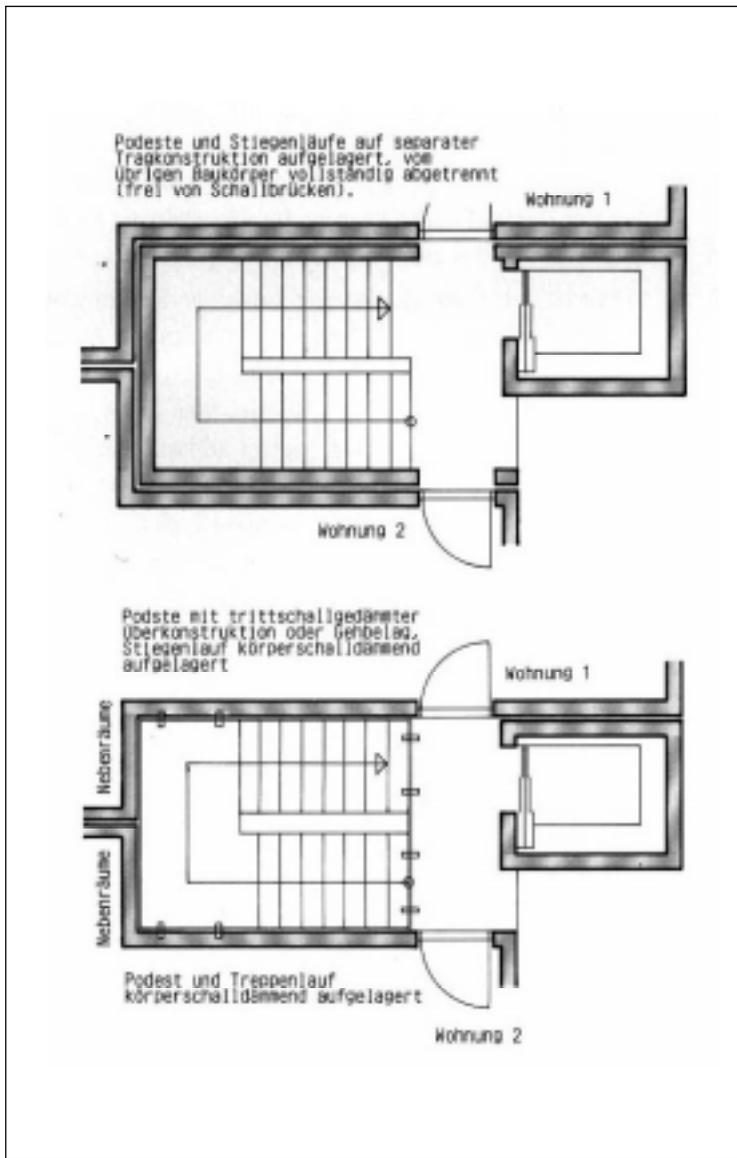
Typische Grundrißlösung zur schalltechnischen Trennung des Aufzugsschachtes
